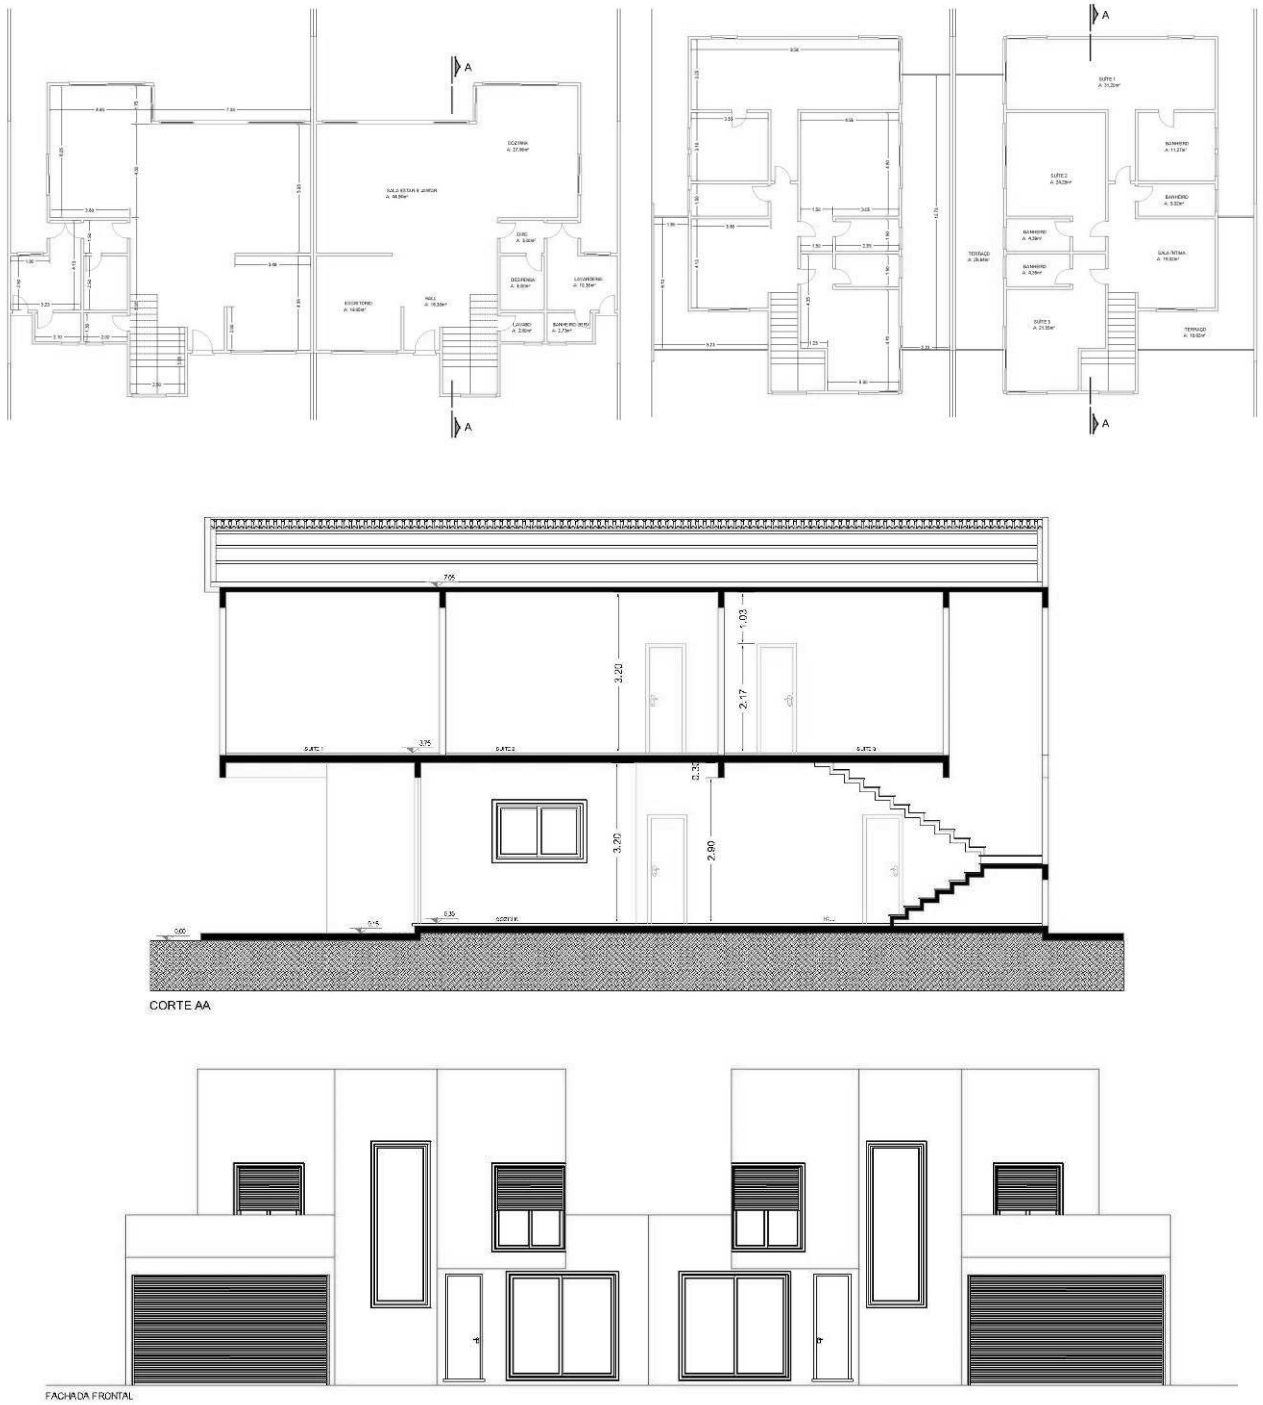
Planta baixa, corte e fachada principal da edificação tipo UH4
